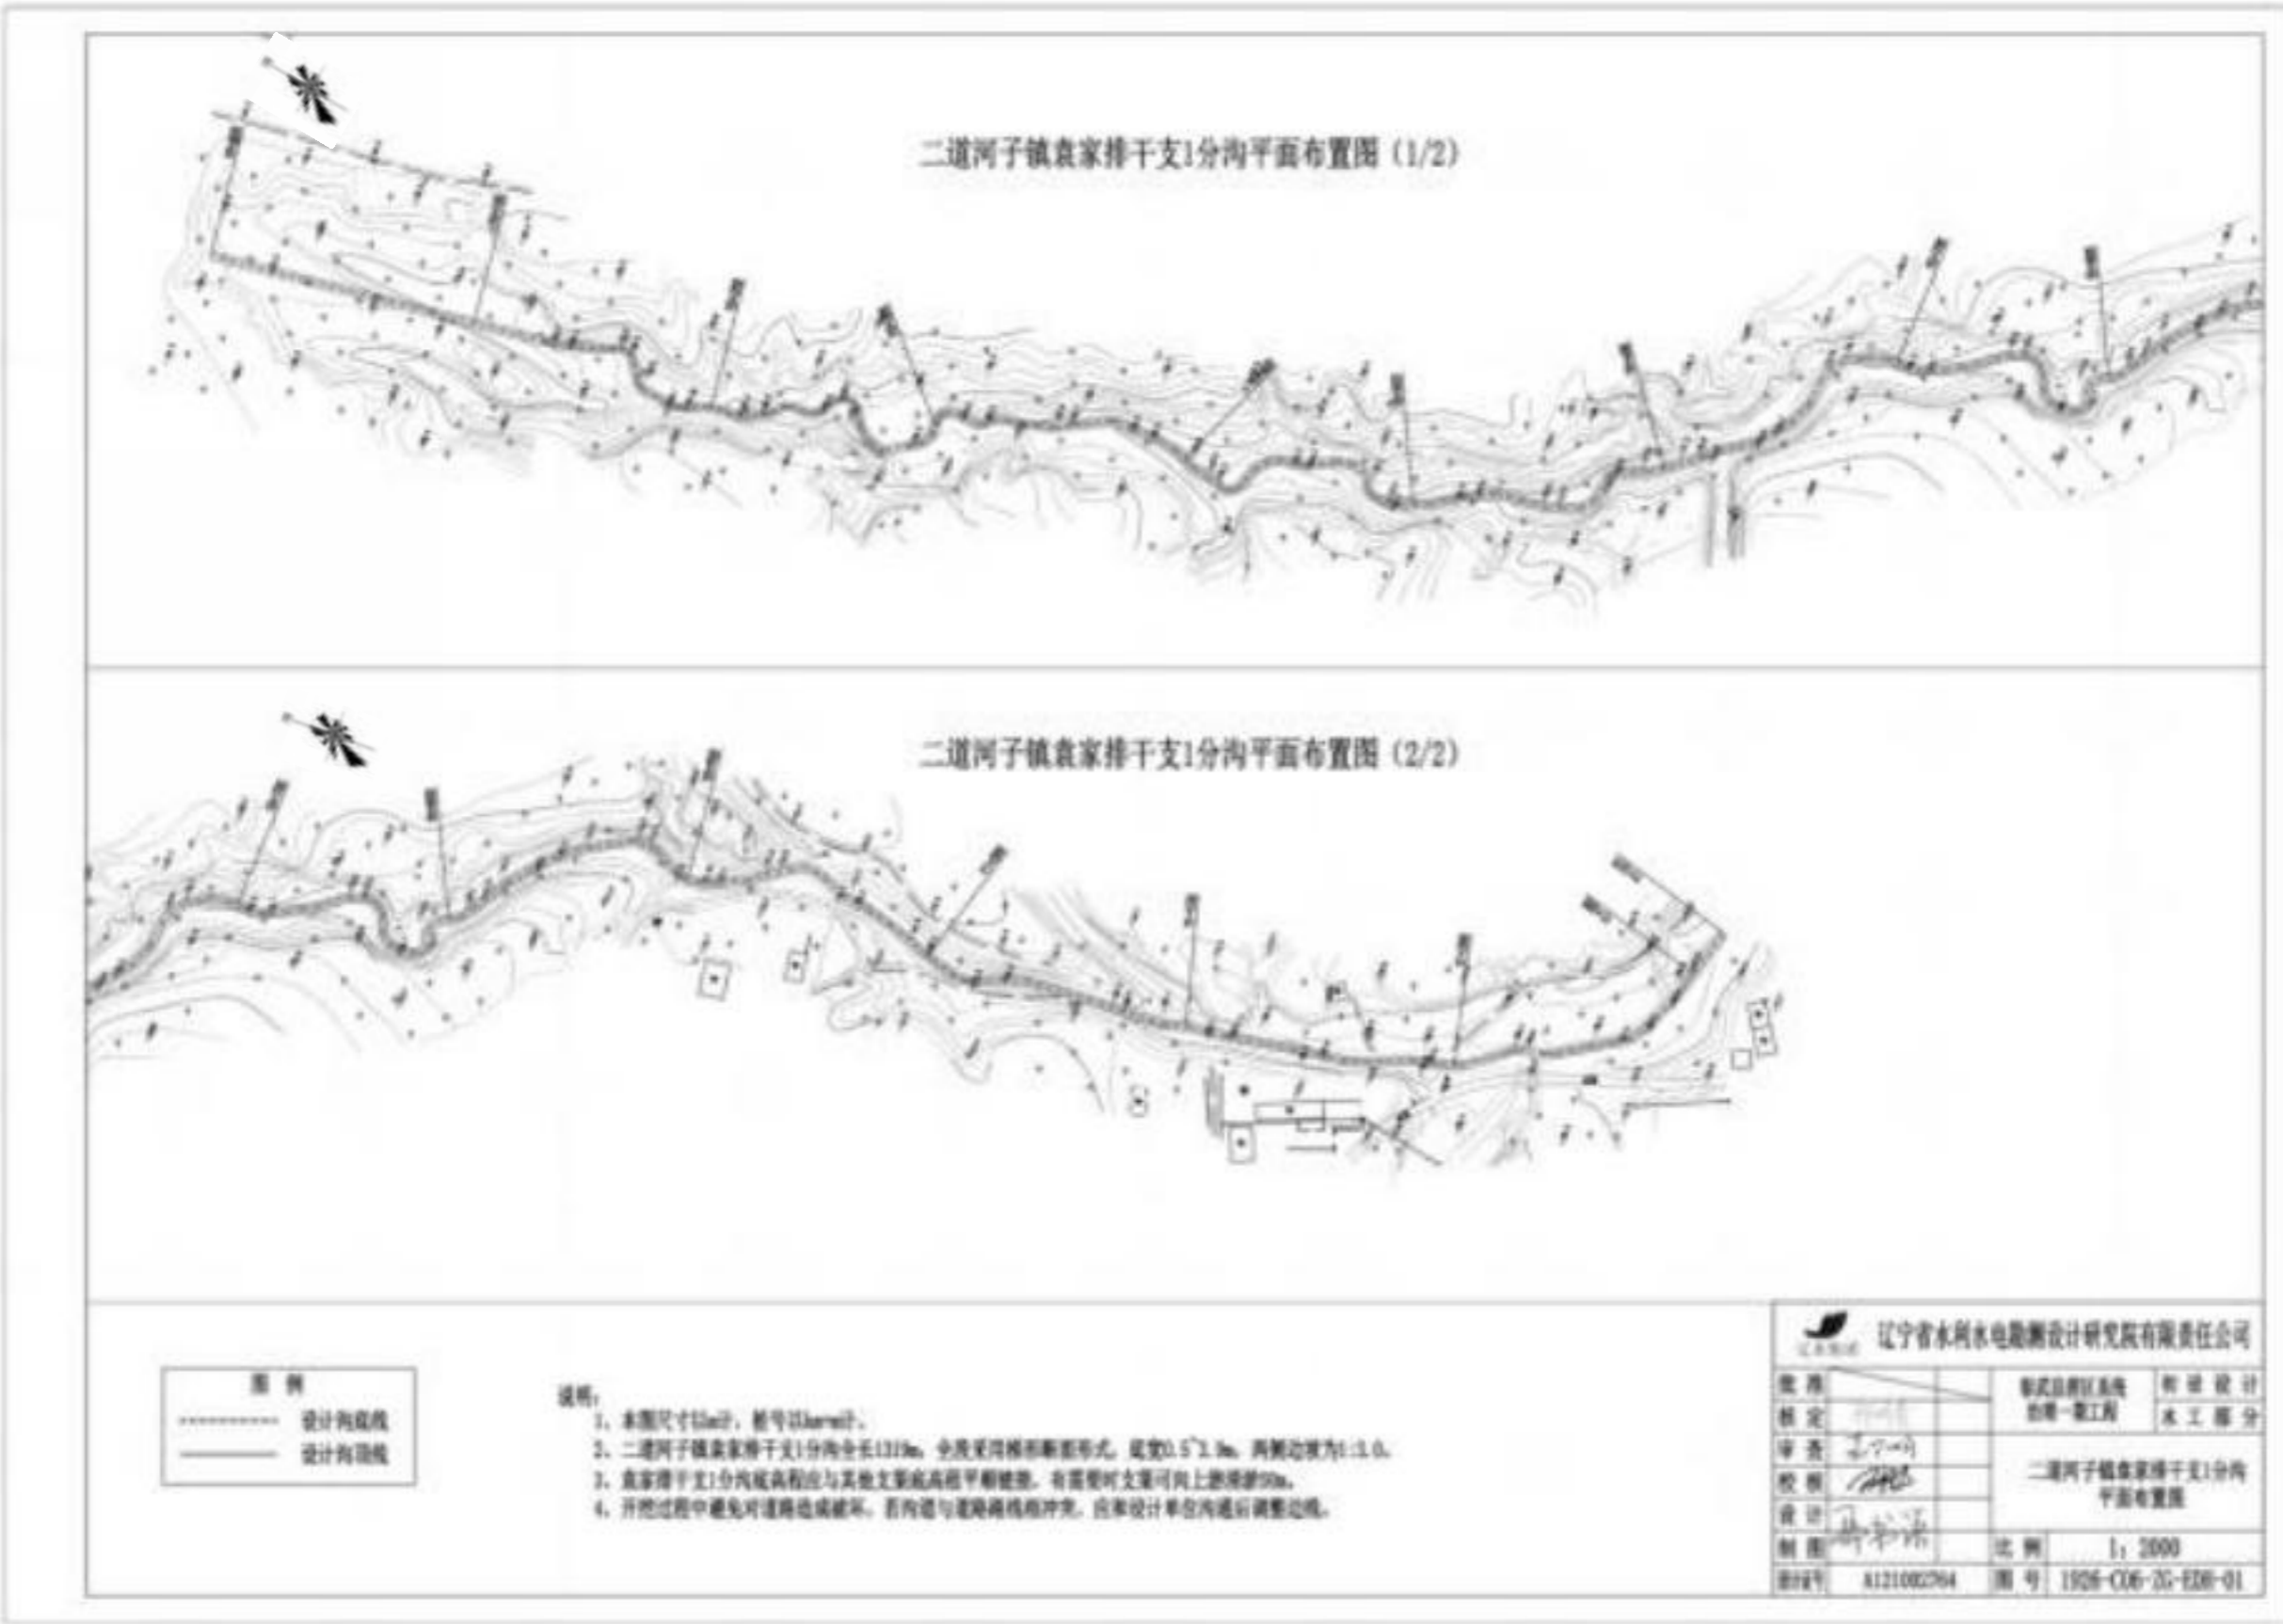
二道河子乡袁家排干支 1 分沟平面布置图
